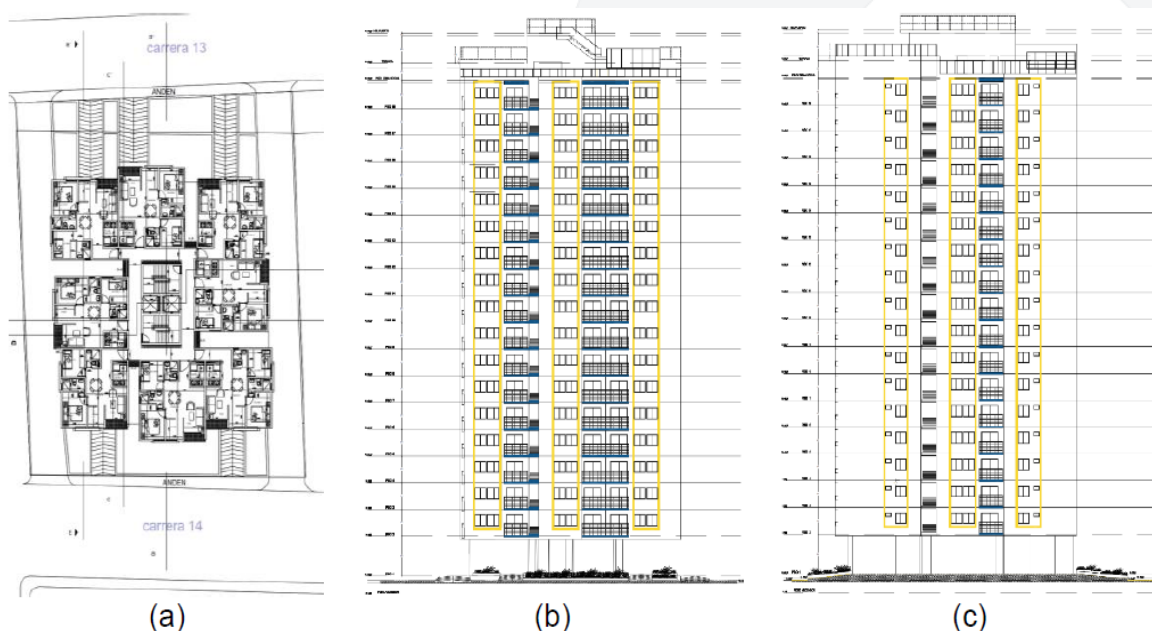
Proyección urbanística del proyecto: a) vista en planta primer piso; b) fachada Carrera 14; c) fachada lateral izquierda, Fuente: solicitante
